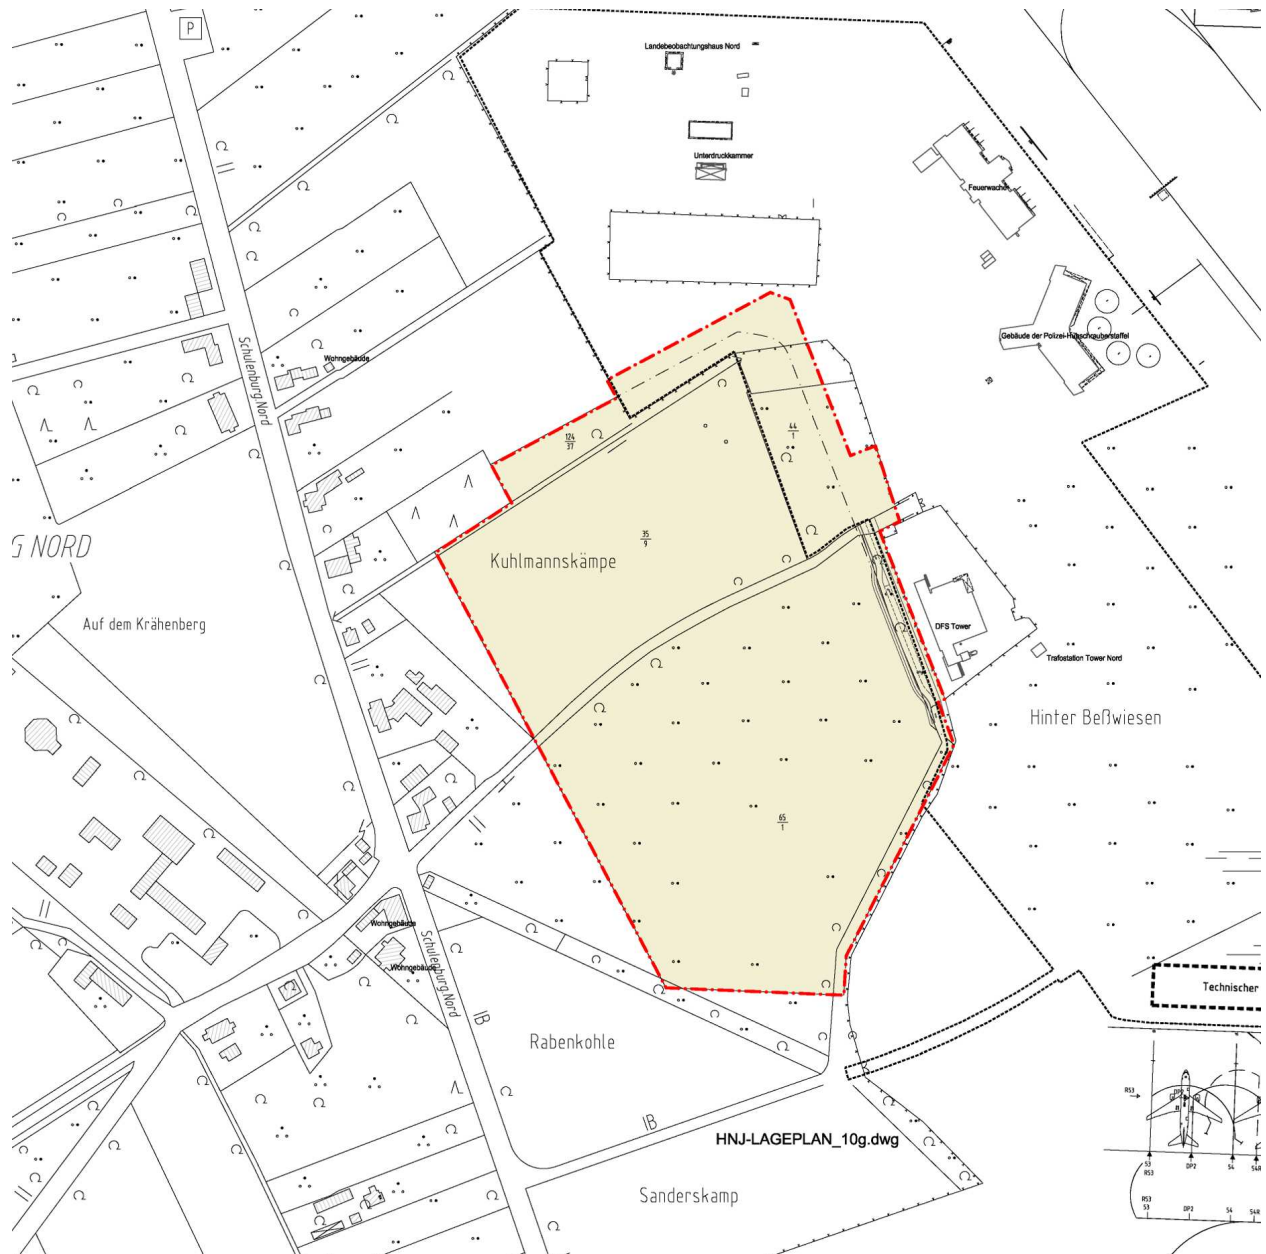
Übersichtslageplan „Geltungsbereich des Bebauungsplanes“
